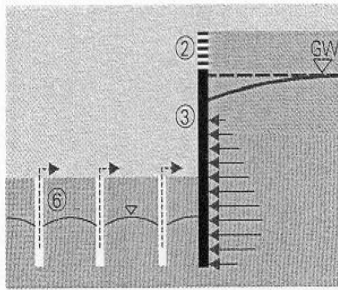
Volle Grundwasserabsenkung [Eisele 2002, S. 87]
